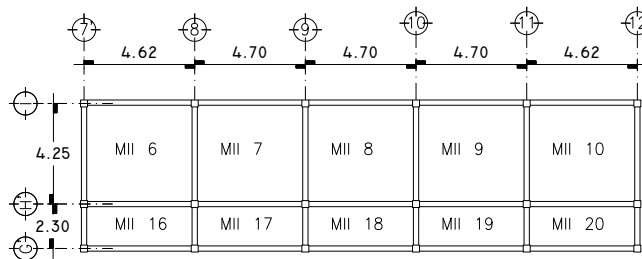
Planta distribución de losas, primer nivel y segundo nivel, módulo IIB
